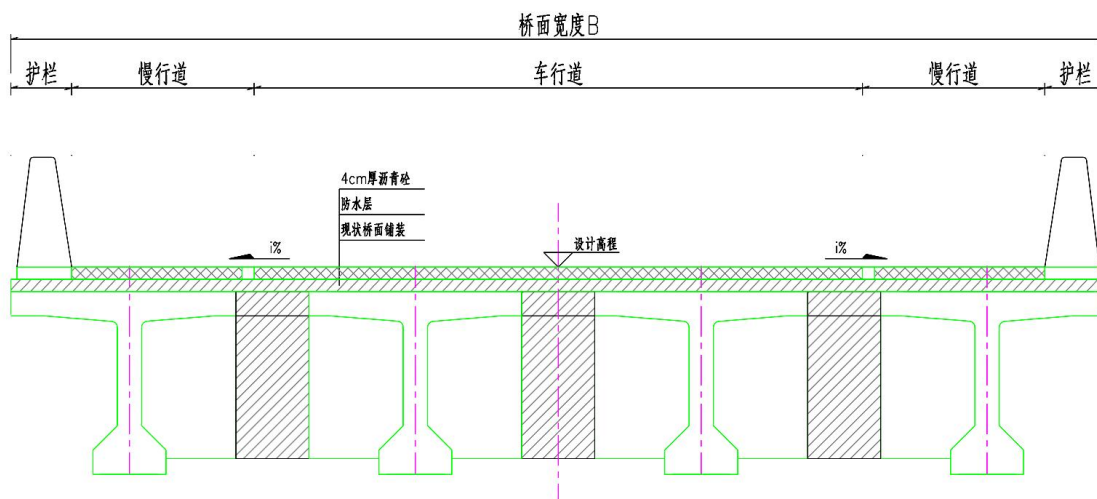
既有桥桥面改造断面示意图（桥梁上部结构仅为示意）
